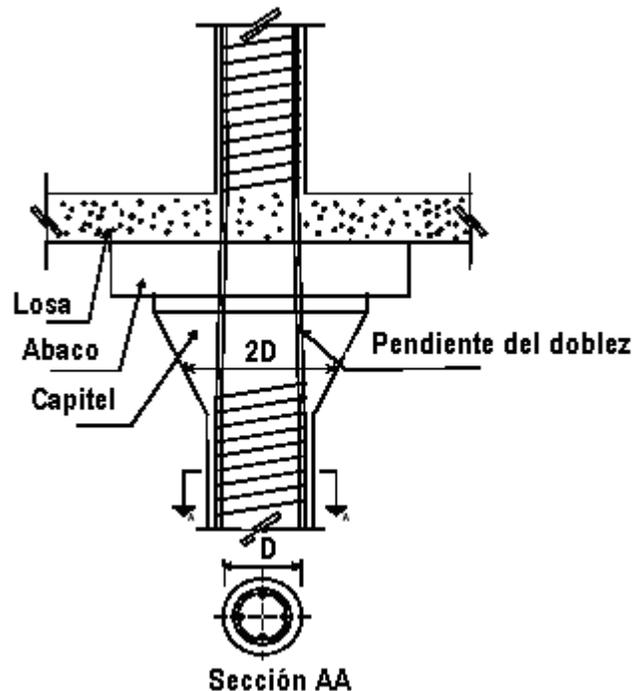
Columnas circulares con refuerzo en espiral
